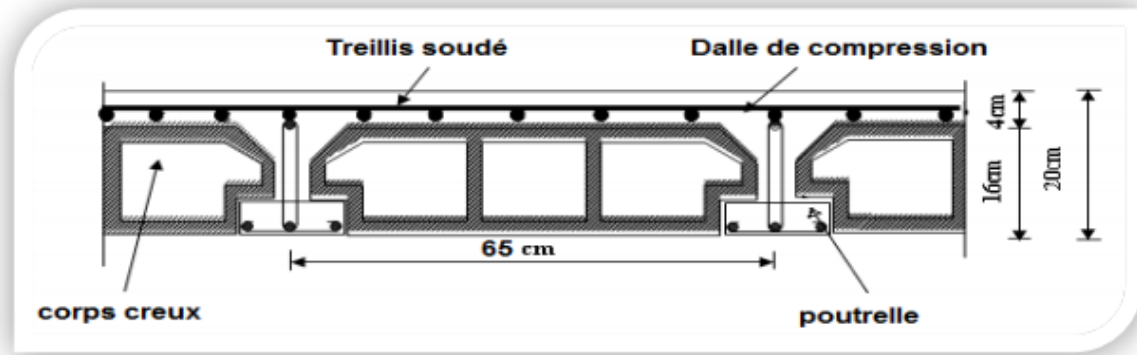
Coupe transversale sur un plancher à corps creux.
